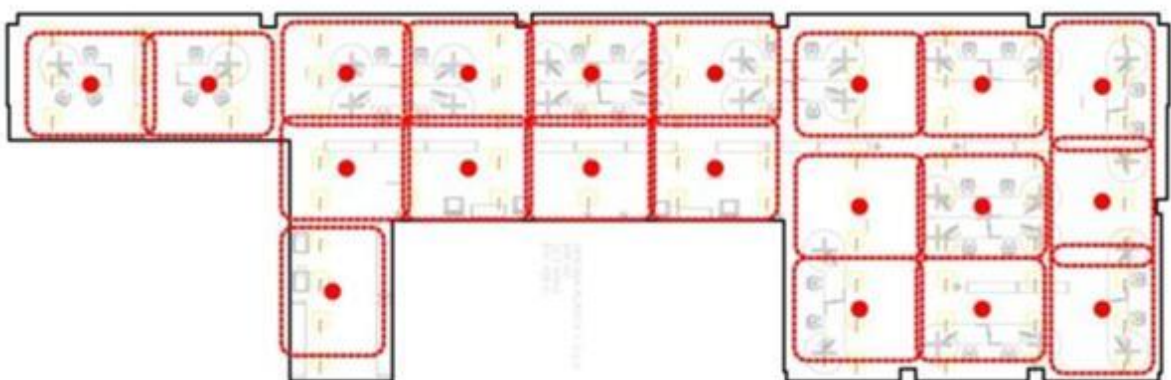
Distribución de Sensores. Área de Trabajo. Planta 1,2 y 3
